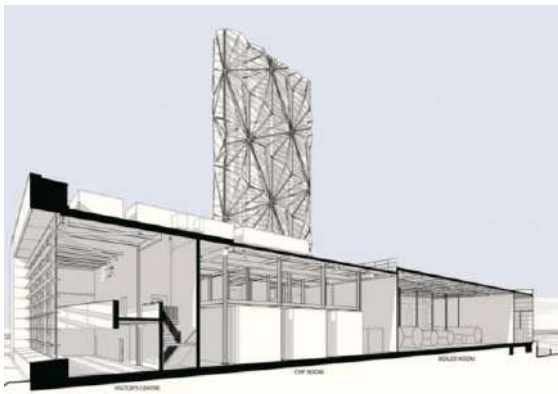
Сечение рабочих корпусов ТЭЦ.
